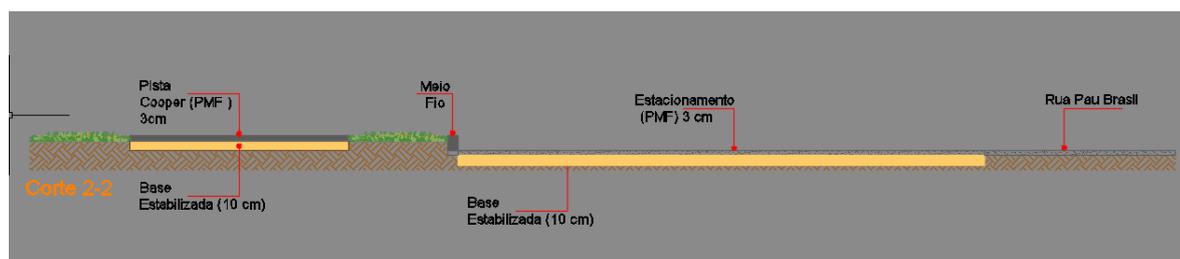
Seção do pavimento, recapeamento em PMF de 3,0 cm
